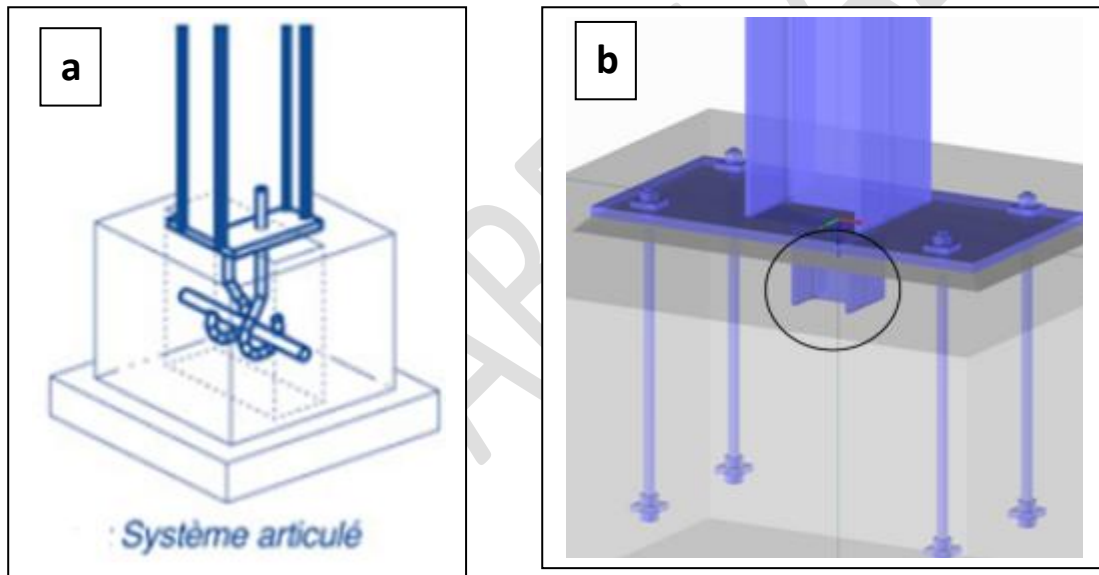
a) Pied de poteau articulé, b) Pied de poteau encastéré
